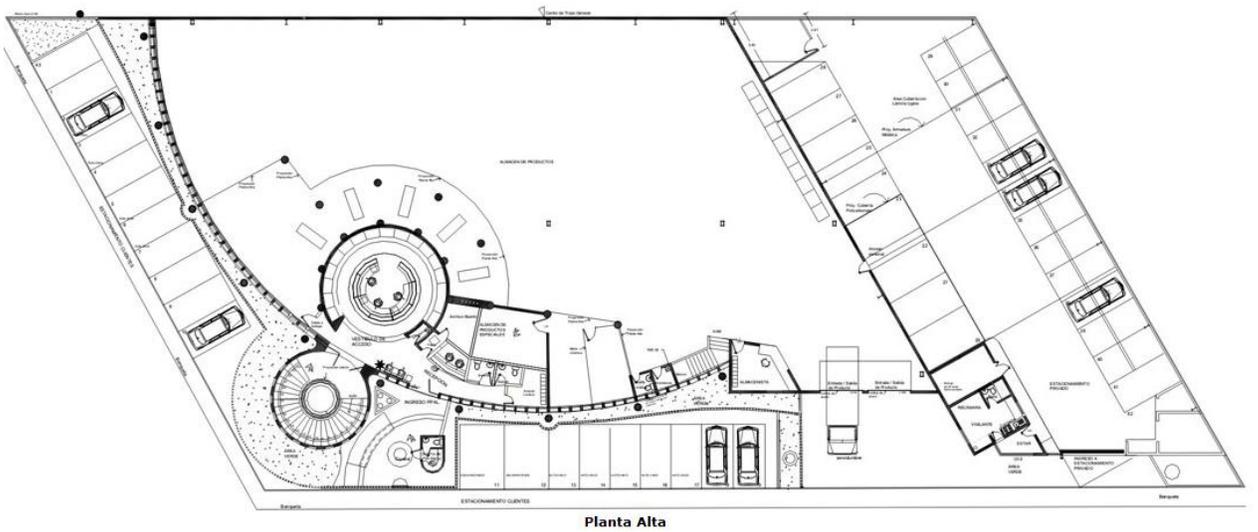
Planta arquitectónica alta. (Sin escala)
